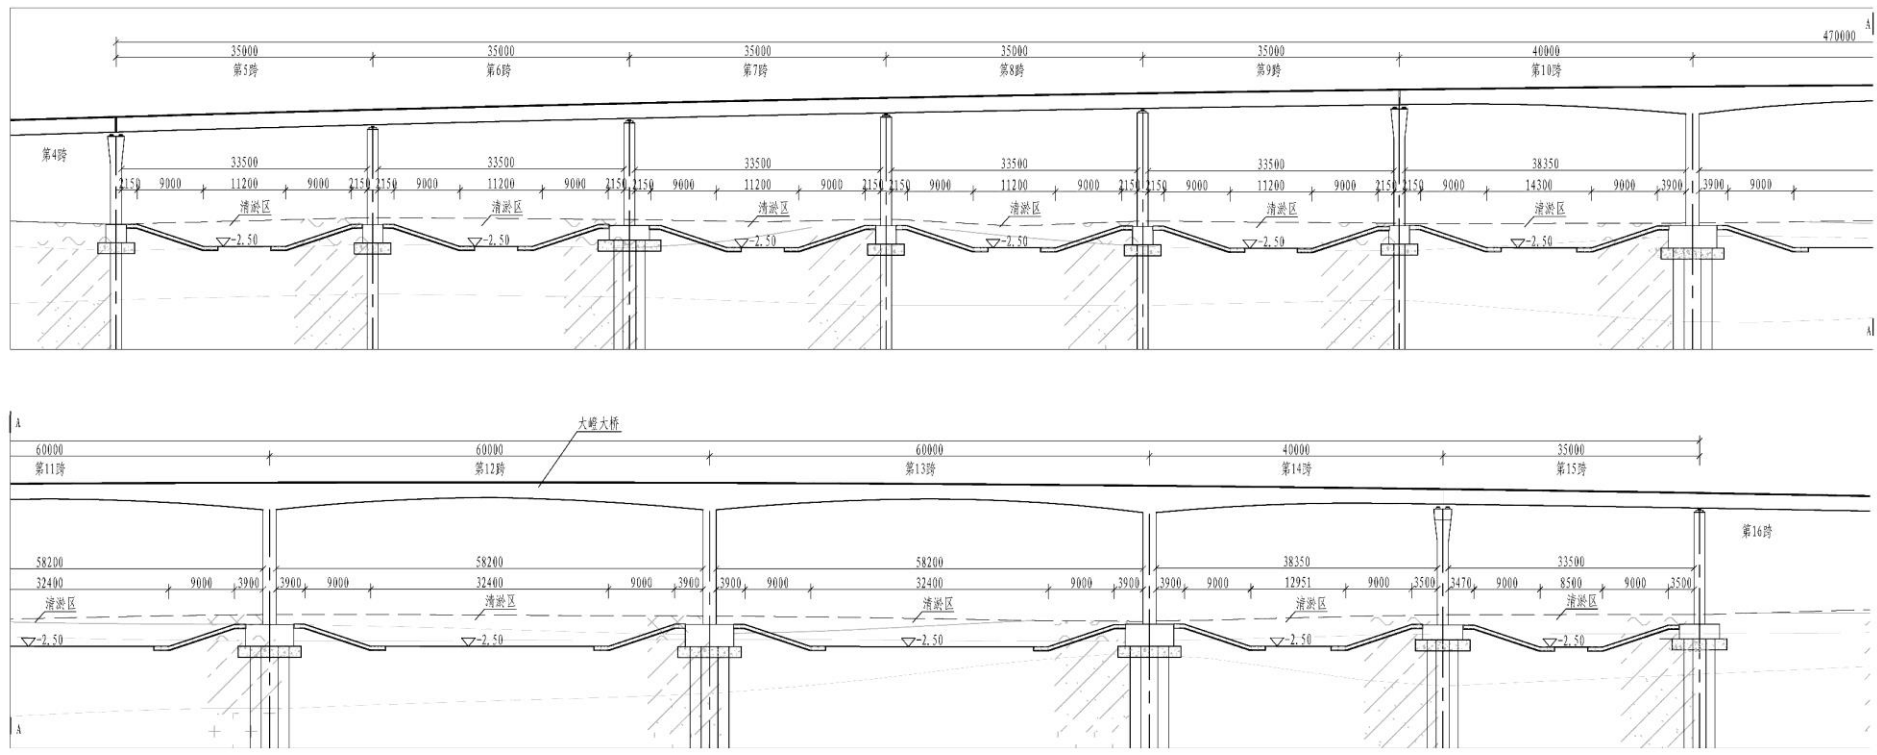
大嶝大桥北侧 B 区断面图 (二)
